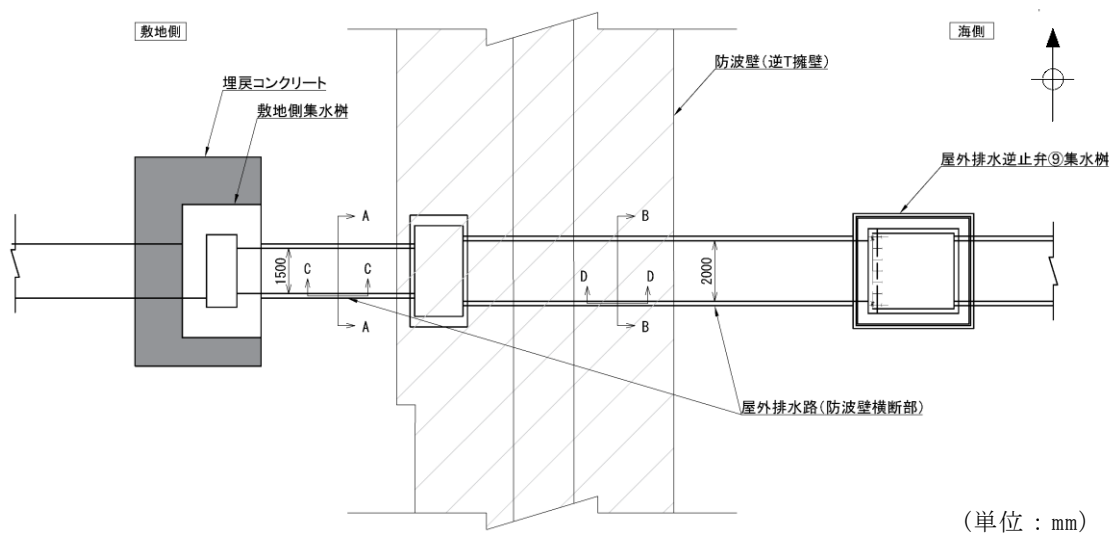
屋外排水路（防波壁横断部）の概略平面図
